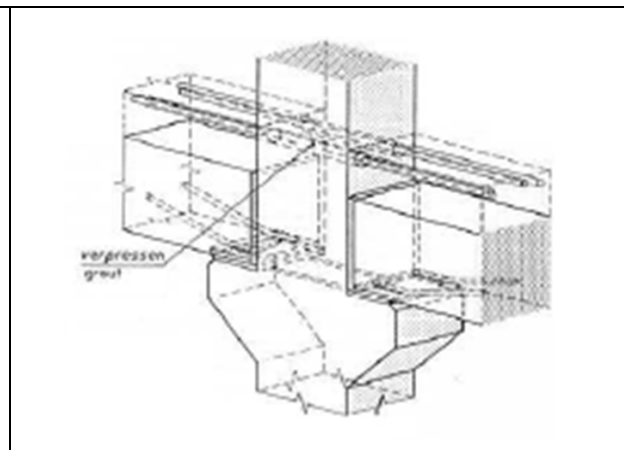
Ligação por consola curta de betão e armadura ordinária (Stupré, 1981)
